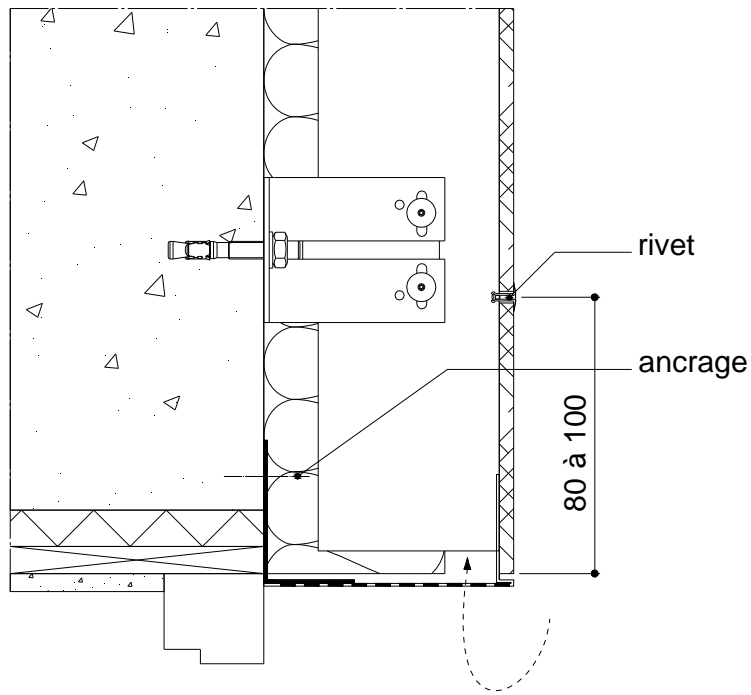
Détail linteau sur ossature métallique (cote en mm)
